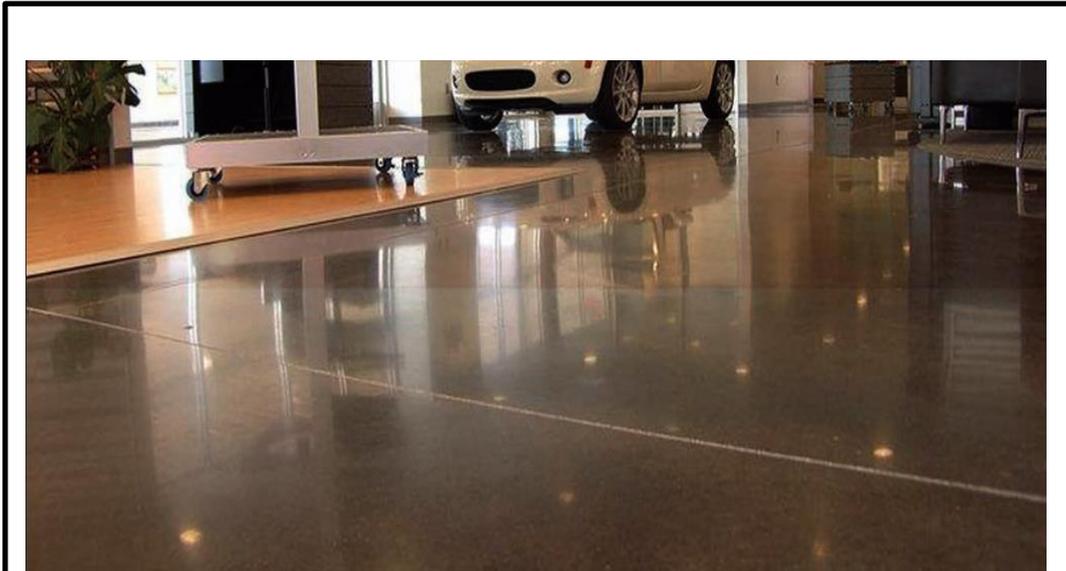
Colocación de las juntas para eliminación de grietas
